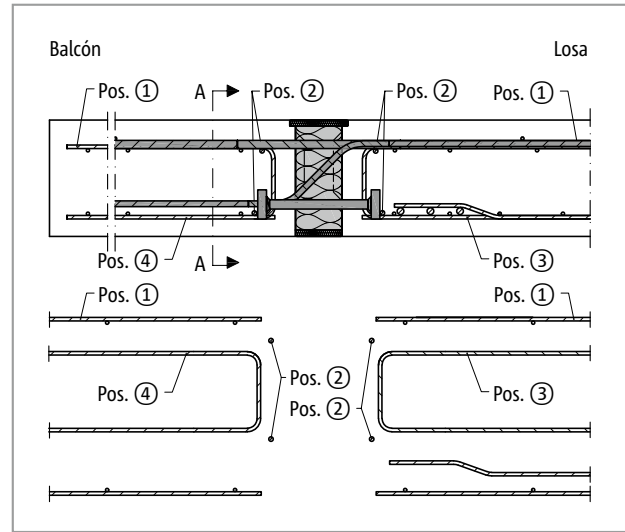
Schöck Isokorb® T tipo K-M12: Armadura in situ en caso de apoyo indirecto
